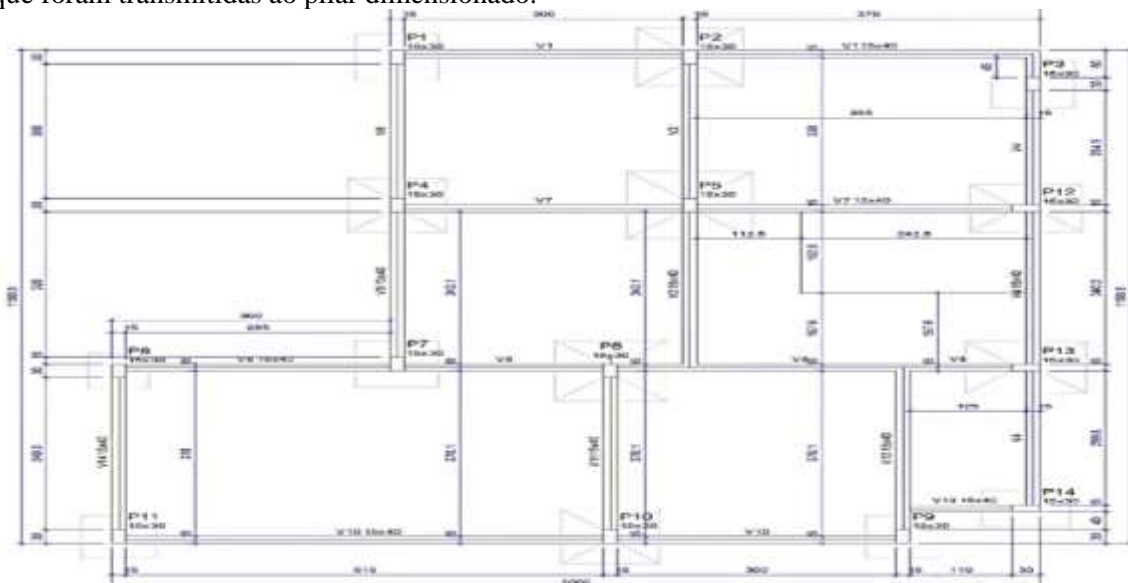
Planta Estrutural e indicação do pilar a ser estudado. Fonte: Autor, 2018.
